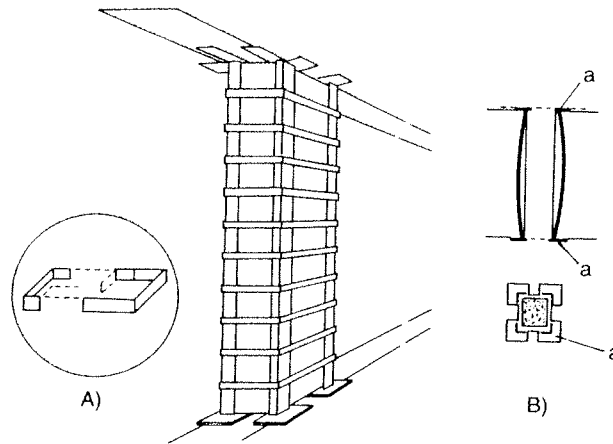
Rinforzo di pilastri con angolari e staffe. A) Particolare della disposizione delle staffe. B) Sezione verticale e pianta schematiche con la disposizione delle piastre di ripartizione (a).
